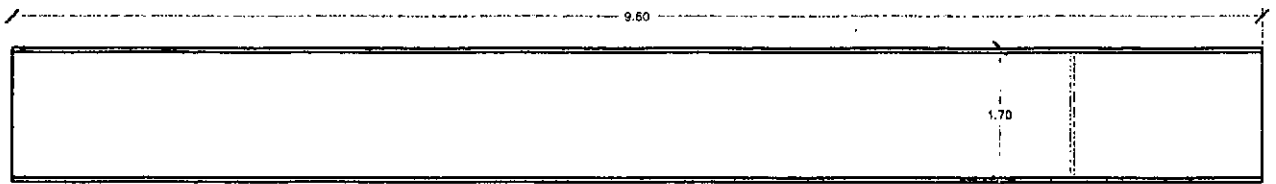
INS P - F9 VISTA FRONTAL PUENTE PEATONAL COLEGIO SCOUT
